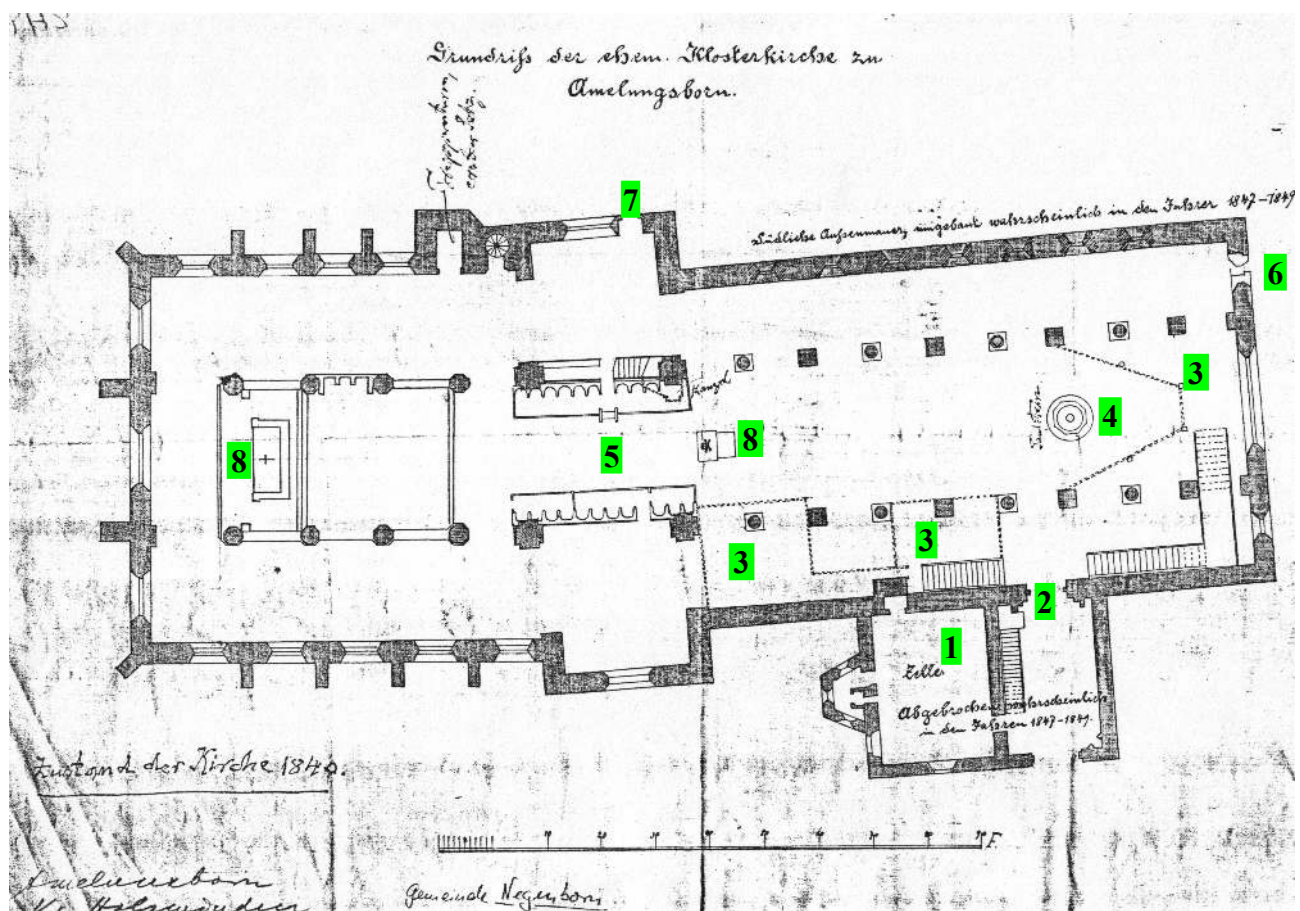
Kirchengrundriss von 1840 Nachlass Dr. Caspers
